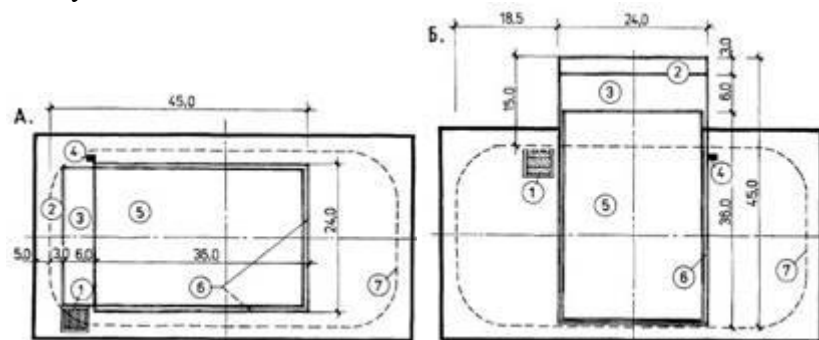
План арены для проведения выступления балета на льду (размеры в метрах)
